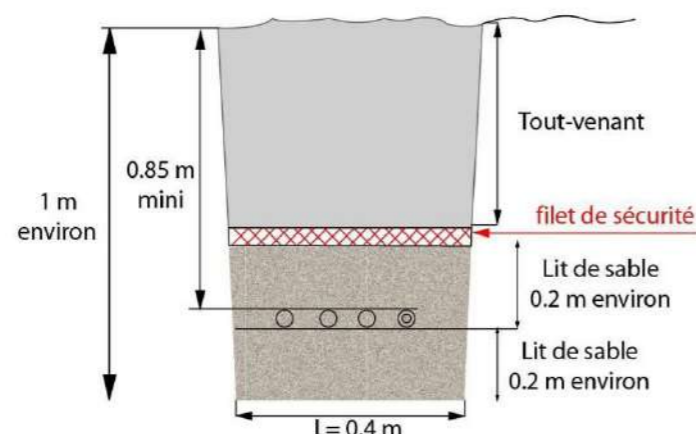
Exemple d'une coupe de tranchée pour enfouissement de ligne
